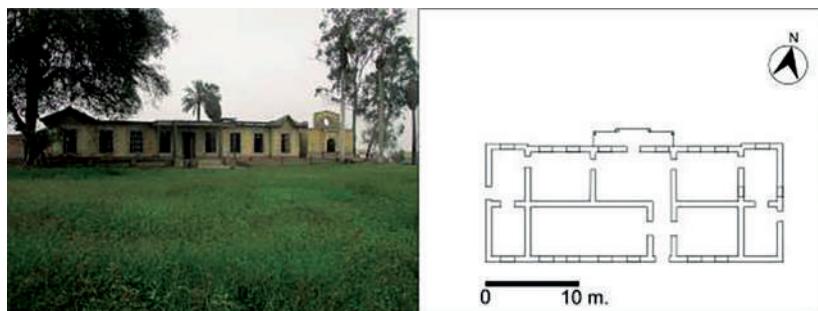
Foto y plano de planta de la casa hacienda Fortín.
